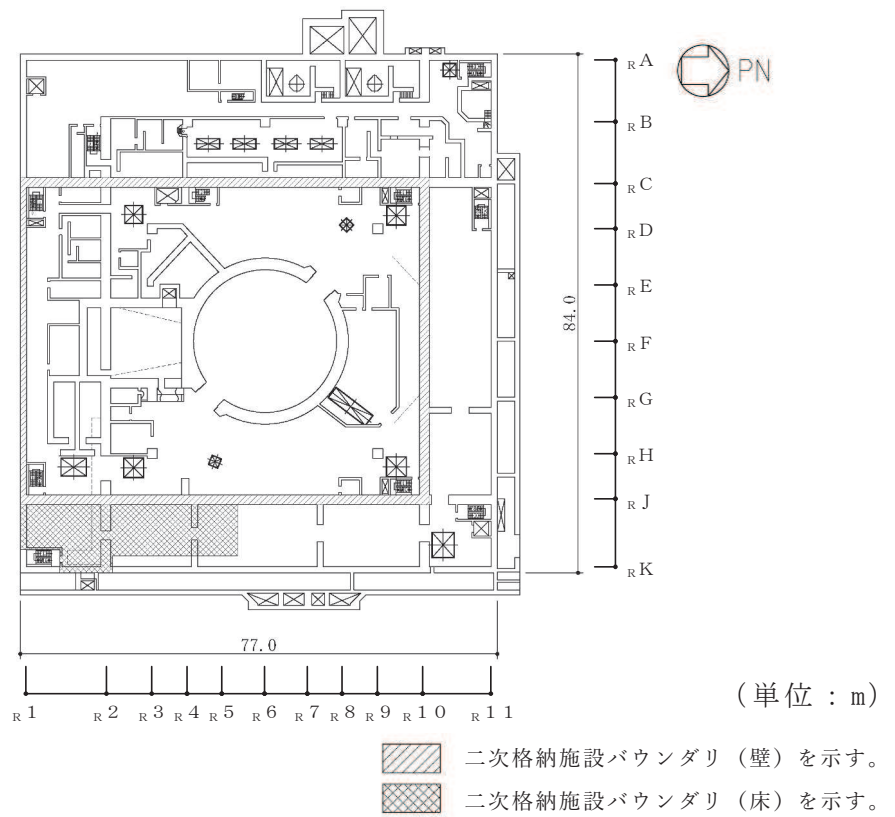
原子炉建屋原子炉棟（二次格納施設）の範囲の平面図
